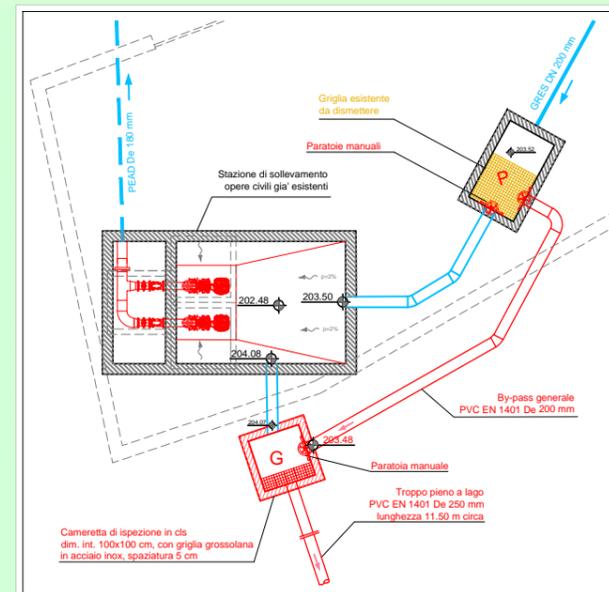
Sistemazione stazione di sollevamento S.S.2 - Pianta
